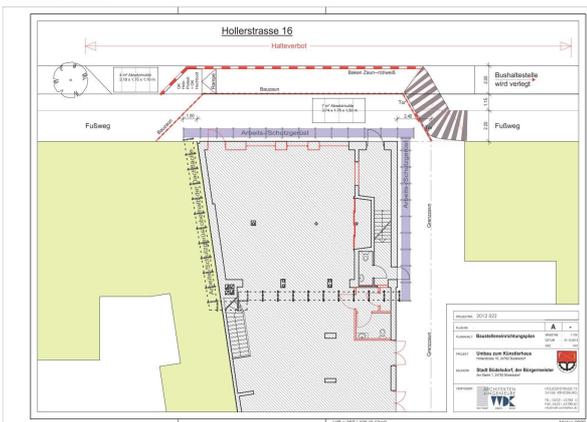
voraussichtliche Baustelleneinrichtung Hollerstraße 16
